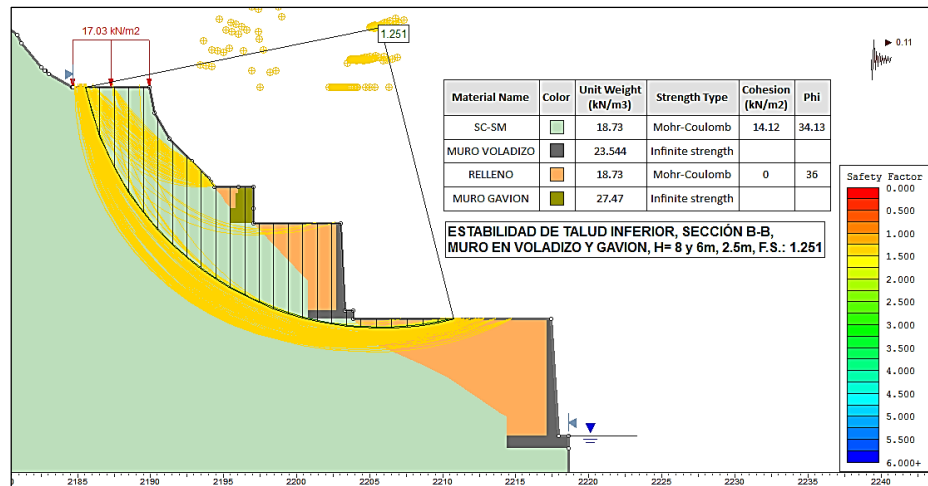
Estabilidad de talud inferior con muros en voladizo y gaviones, Sección B-B.
